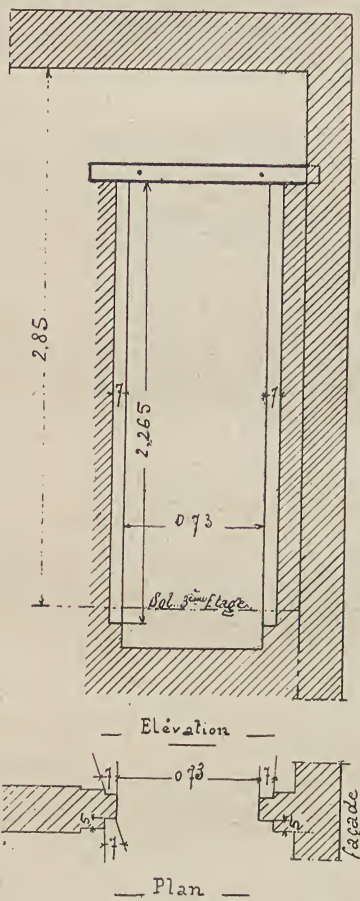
Elevation et plan des entailles dans la brique de bâti et contre-bâti.
